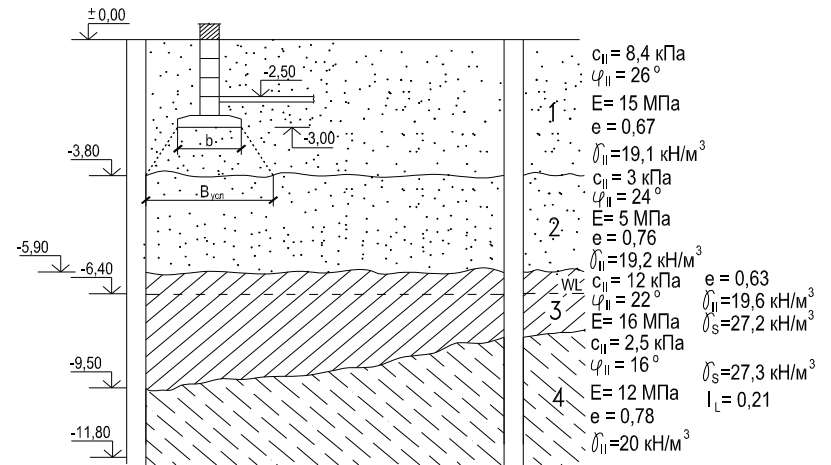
Геологический профиль строительной площадки (см. пример 2.4):
